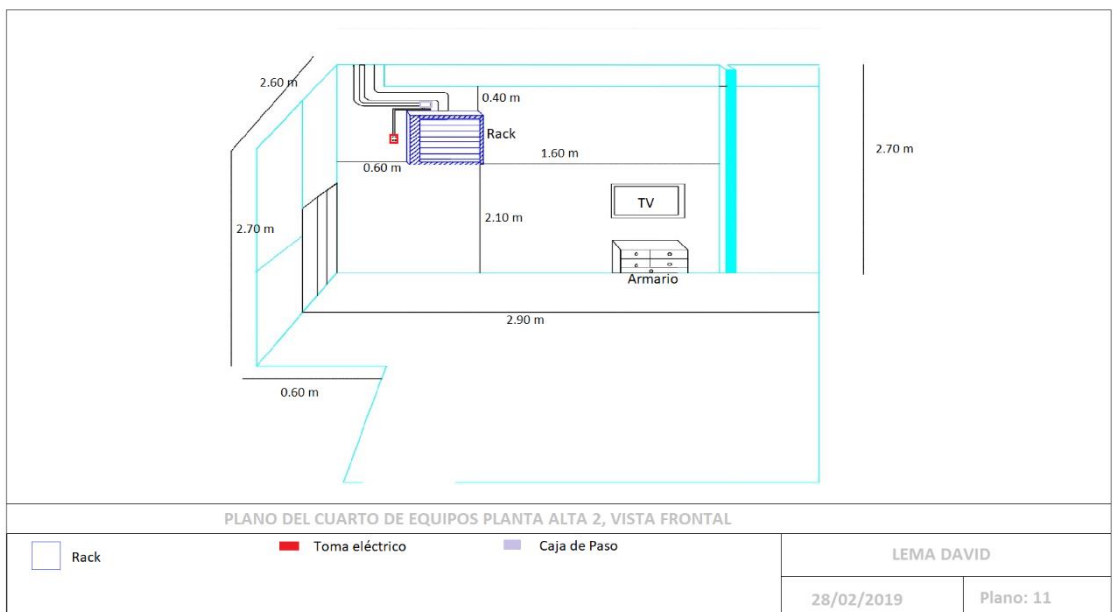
Plano de cuarto de equipo planta alta, vista frontal.
